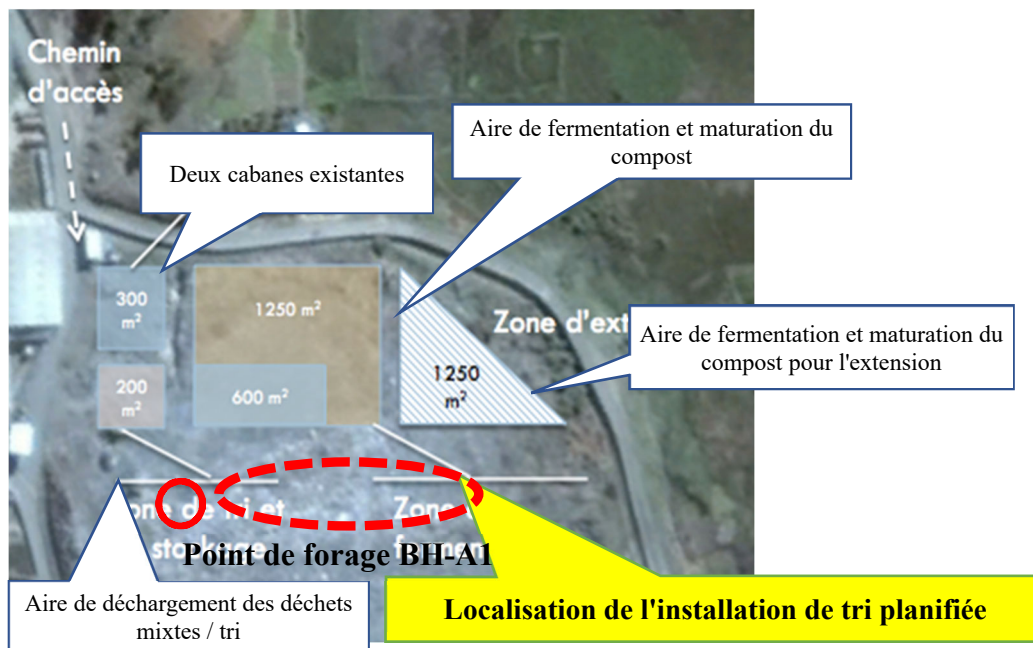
Plan de disposition de l'installation de tri planifiée
